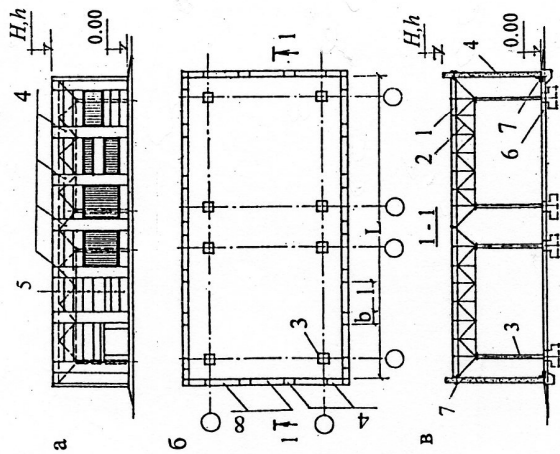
Бесфакерковые стены с горизонтально-вертикальной раскладкой панелей
